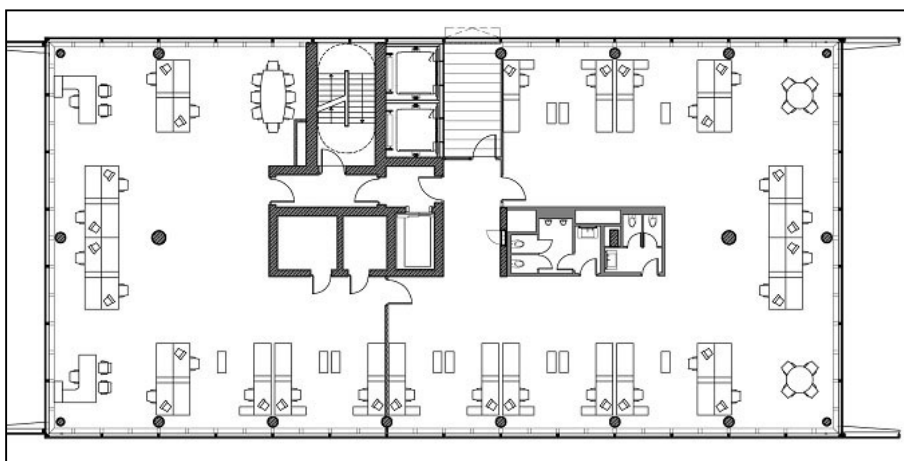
Beispiel für den Grundriss eines Großraumbüros
